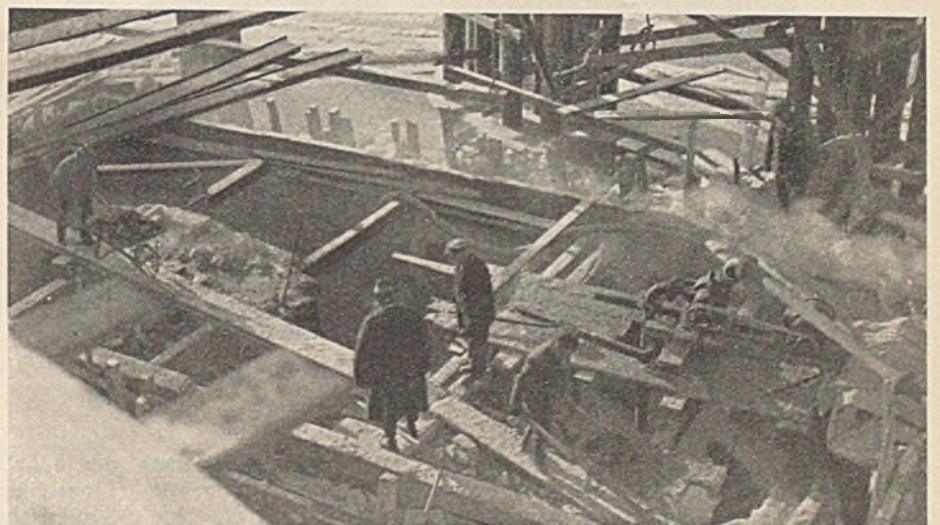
An der Beseitigung des unteren Teiles des Pfeilers 4 wird gearbeitet.
